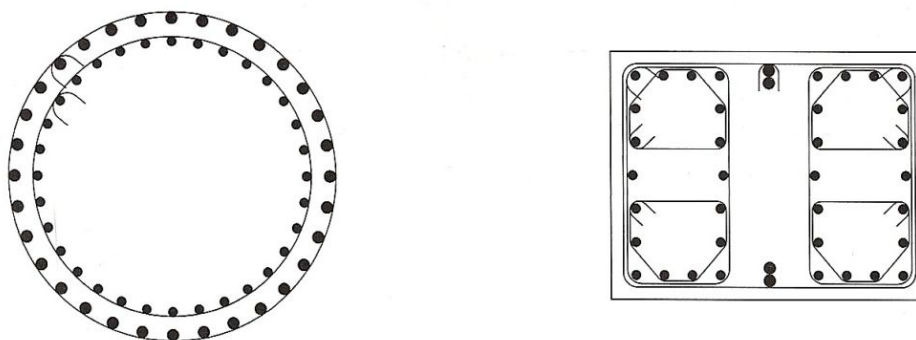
Secções tipo de pilares de betão (Eisele; Kloft, 1999)
